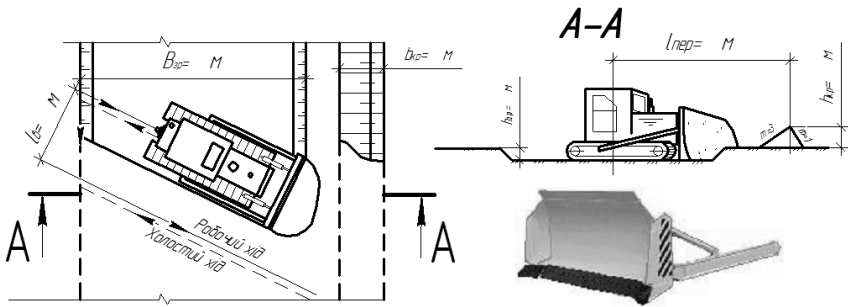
Схема зрізки рослинного шару ґрунту за поперечною схемою (на схемі також зображено відвал – робочий орган бульдозера)
